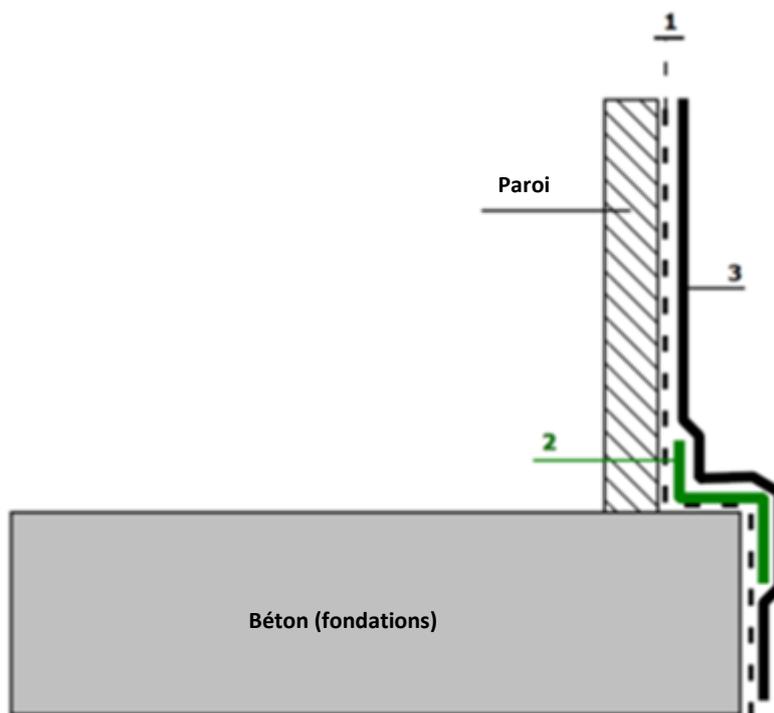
Détail transition fondations / paroi ⁽ⁱ⁾
